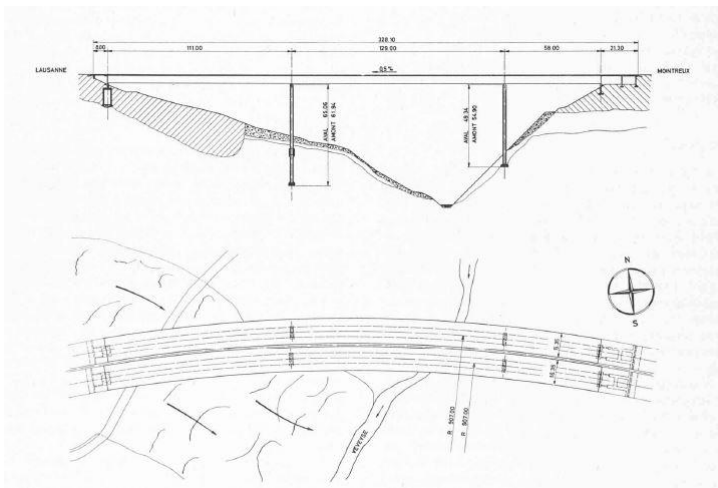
Le pont sur la Veveys, Schnitt und Grundriss
